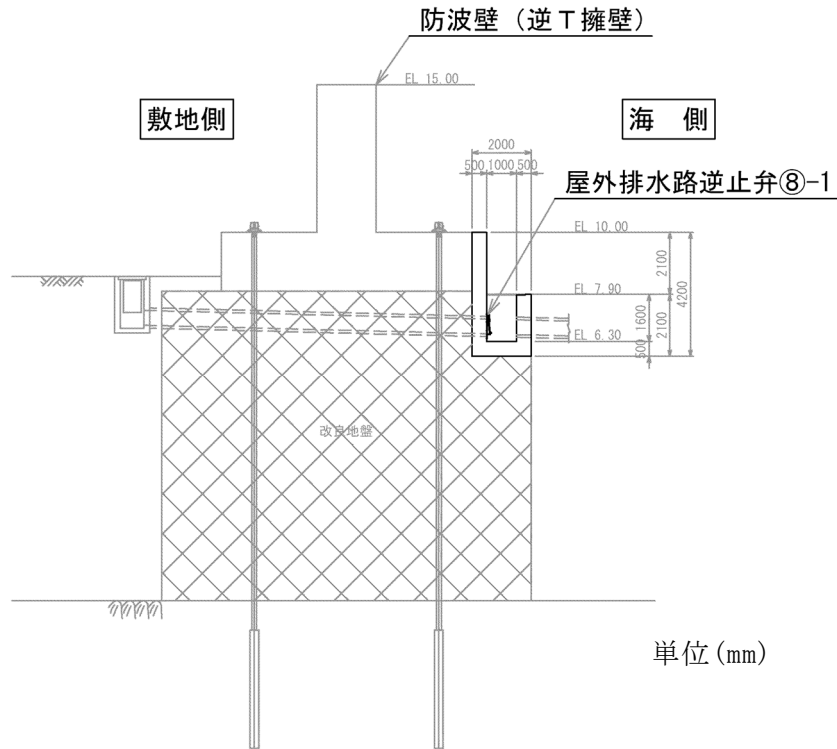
(2) 屋外排水路逆止弁⑧-1 断面图
